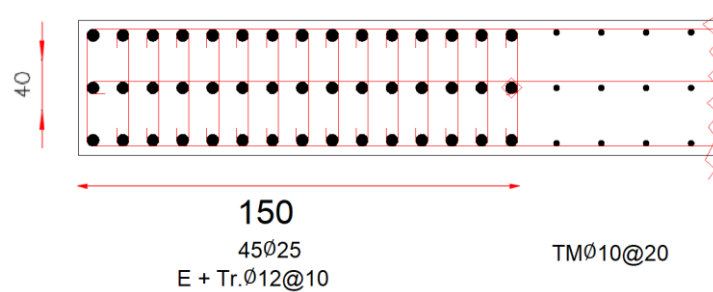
Corte que muestra la disposición de armadura en uno de los extremos muro R modelo de 30 pisos.
